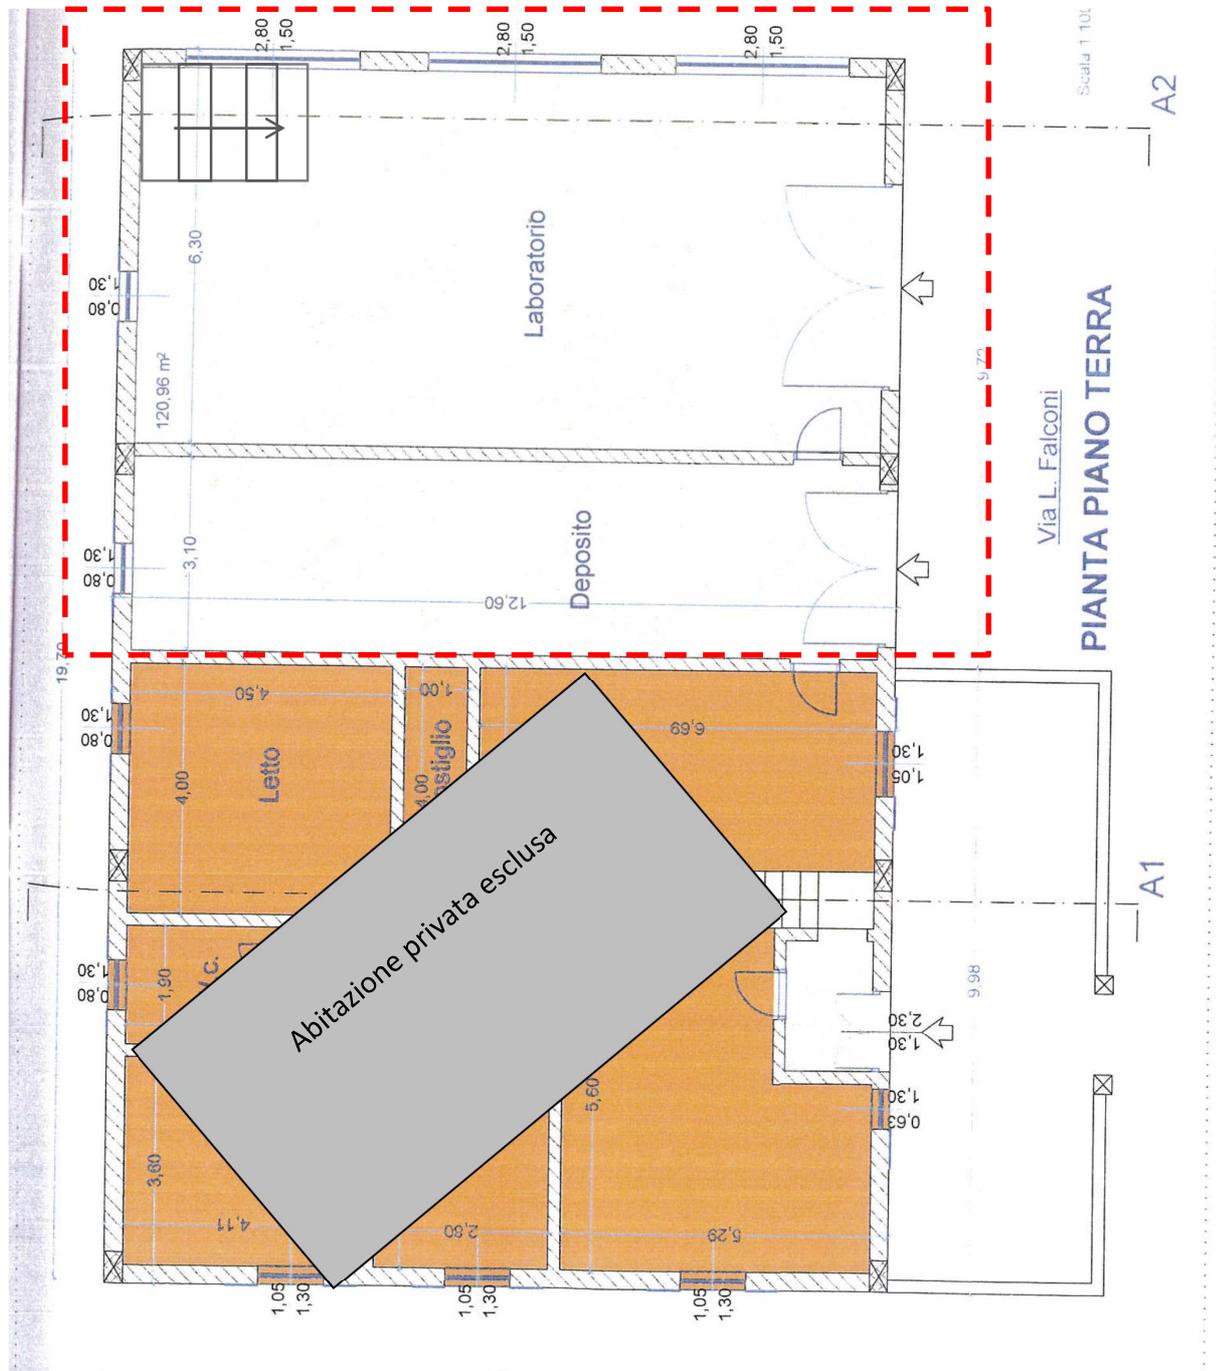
Planimetria della falegnameria presente agli atti.
